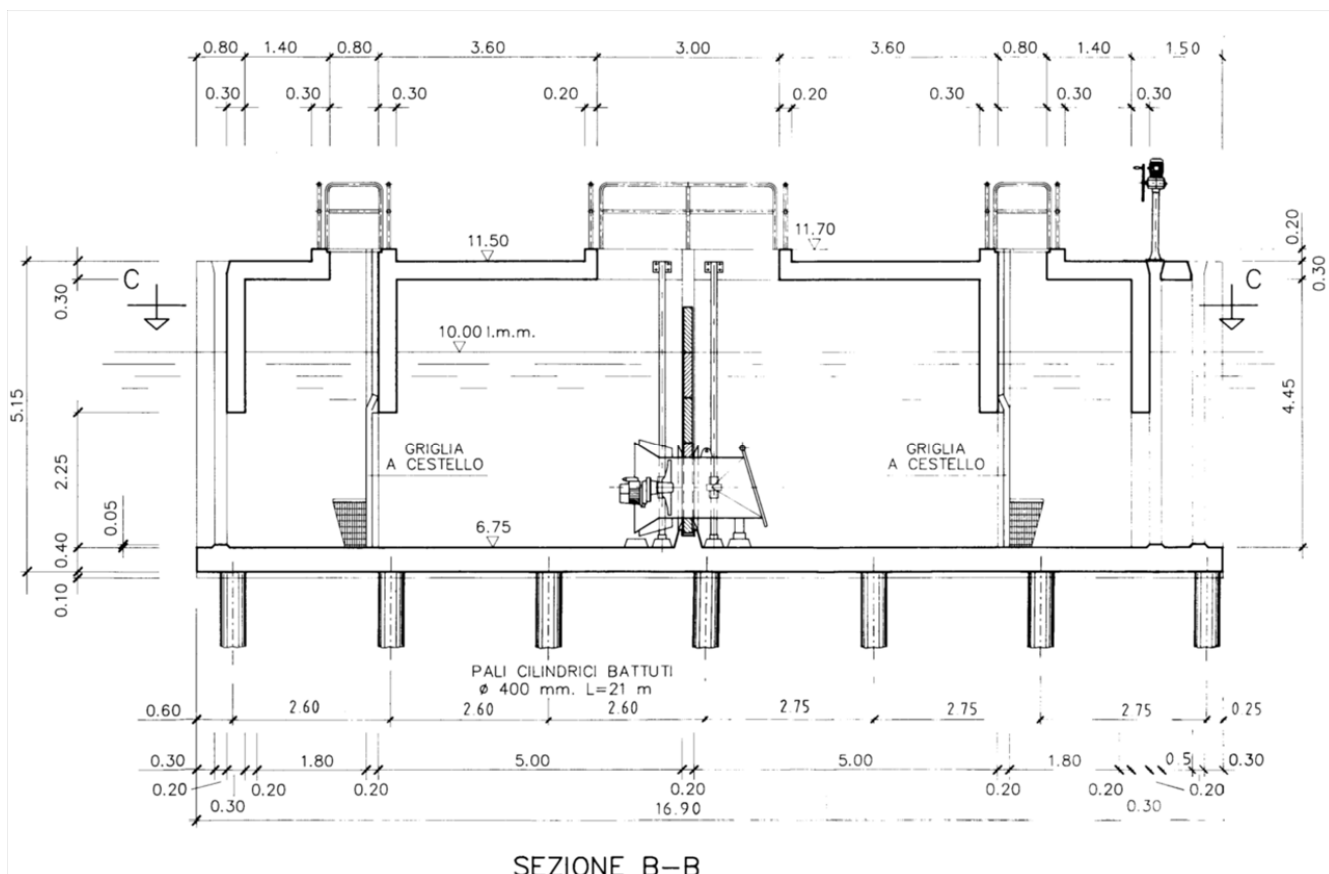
Sezione B-B dell'impianto idrovoro Lanterna Vecchia
